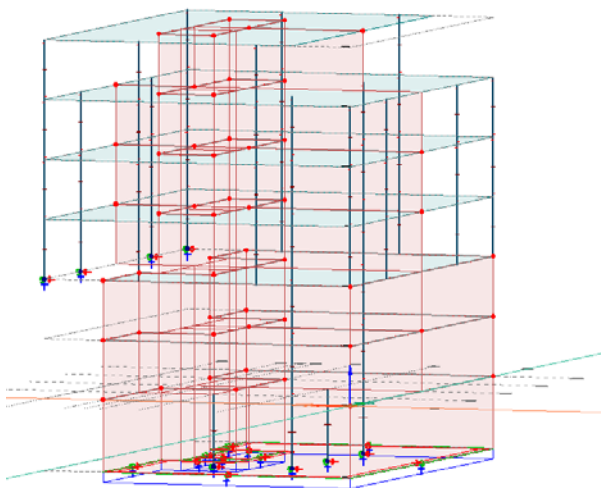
Dekketykkelse på slakkarmert, plass-støpte betongdekker
